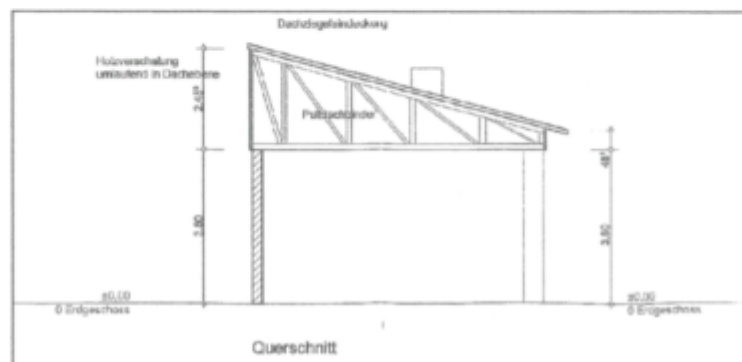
Querschnitt Bildhauerwerkstatt (Quelle: Architekturbüro G. Eisold 2008)
